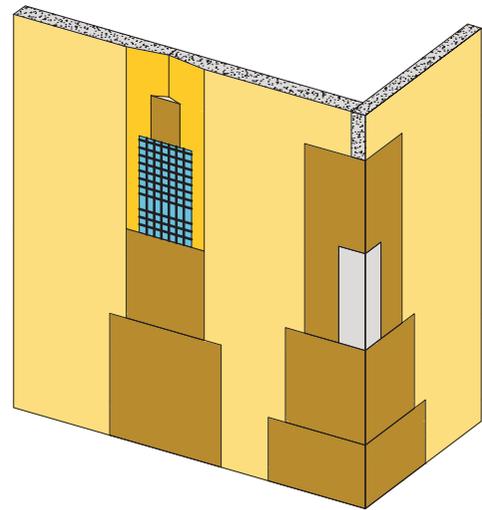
Detalle de tratamiento de junta invisible en placas de yeso-cartón (Fuente: CDT)
